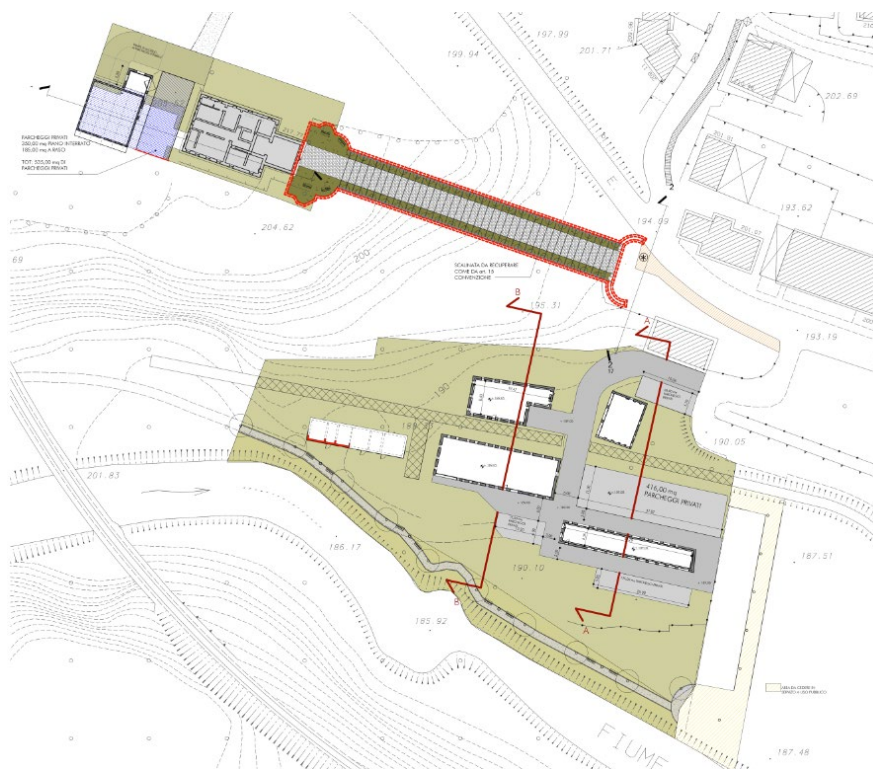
stralcio tavola 13 del piano di recupero, "planimetria generale di progetto e sezioni edifici da recuperare"
